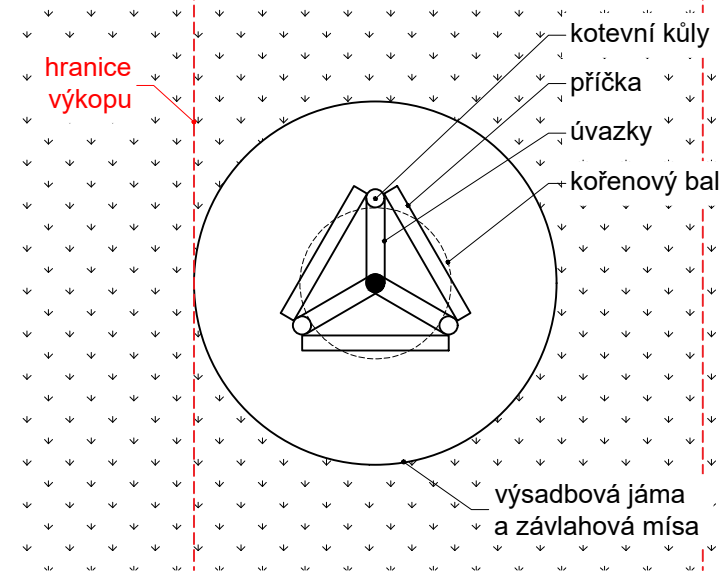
# DETAILY VÝSADBOVÝCH JAM TYP A, TYP B, TYP C, M1:25
